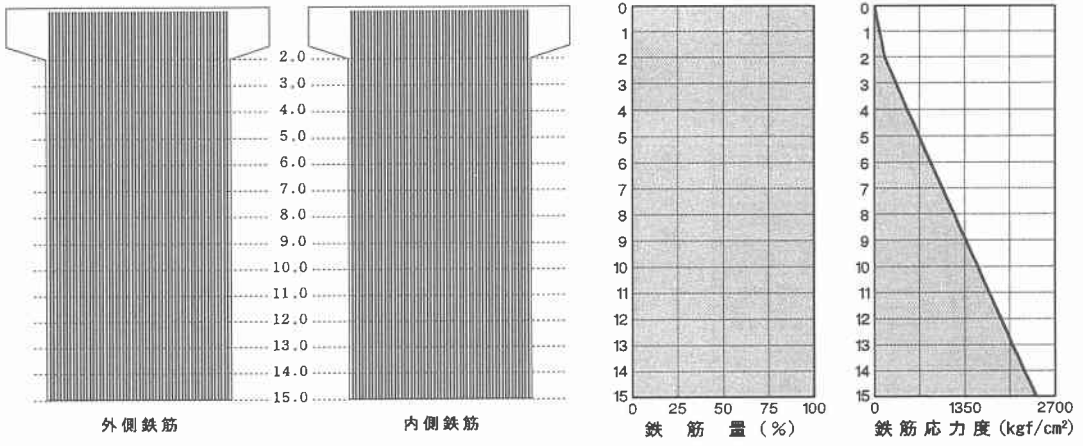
段落しなしの場合 (Case-1) の配筋と鉄筋応力度
